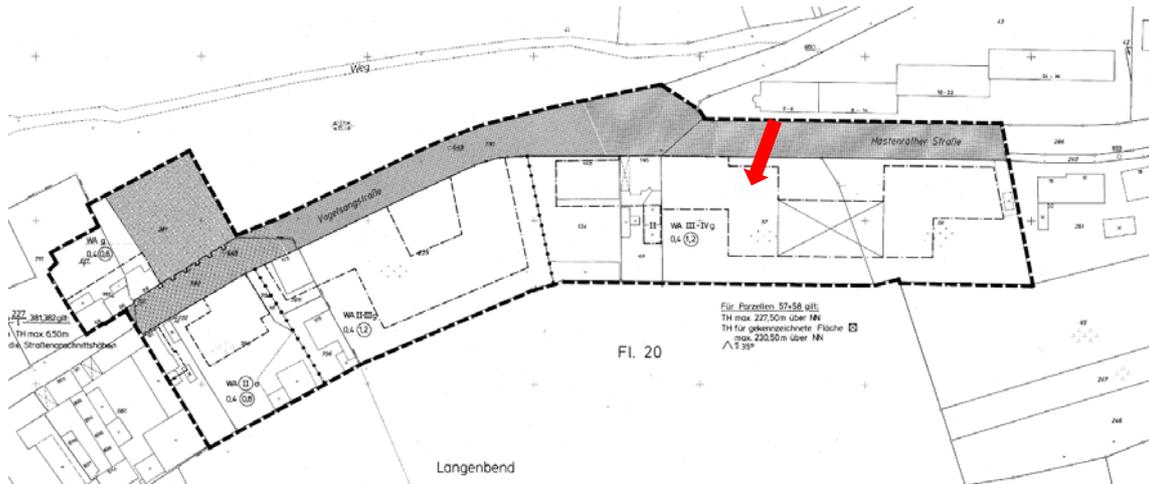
Auszug aus Bebauungsplan Nr. 102
